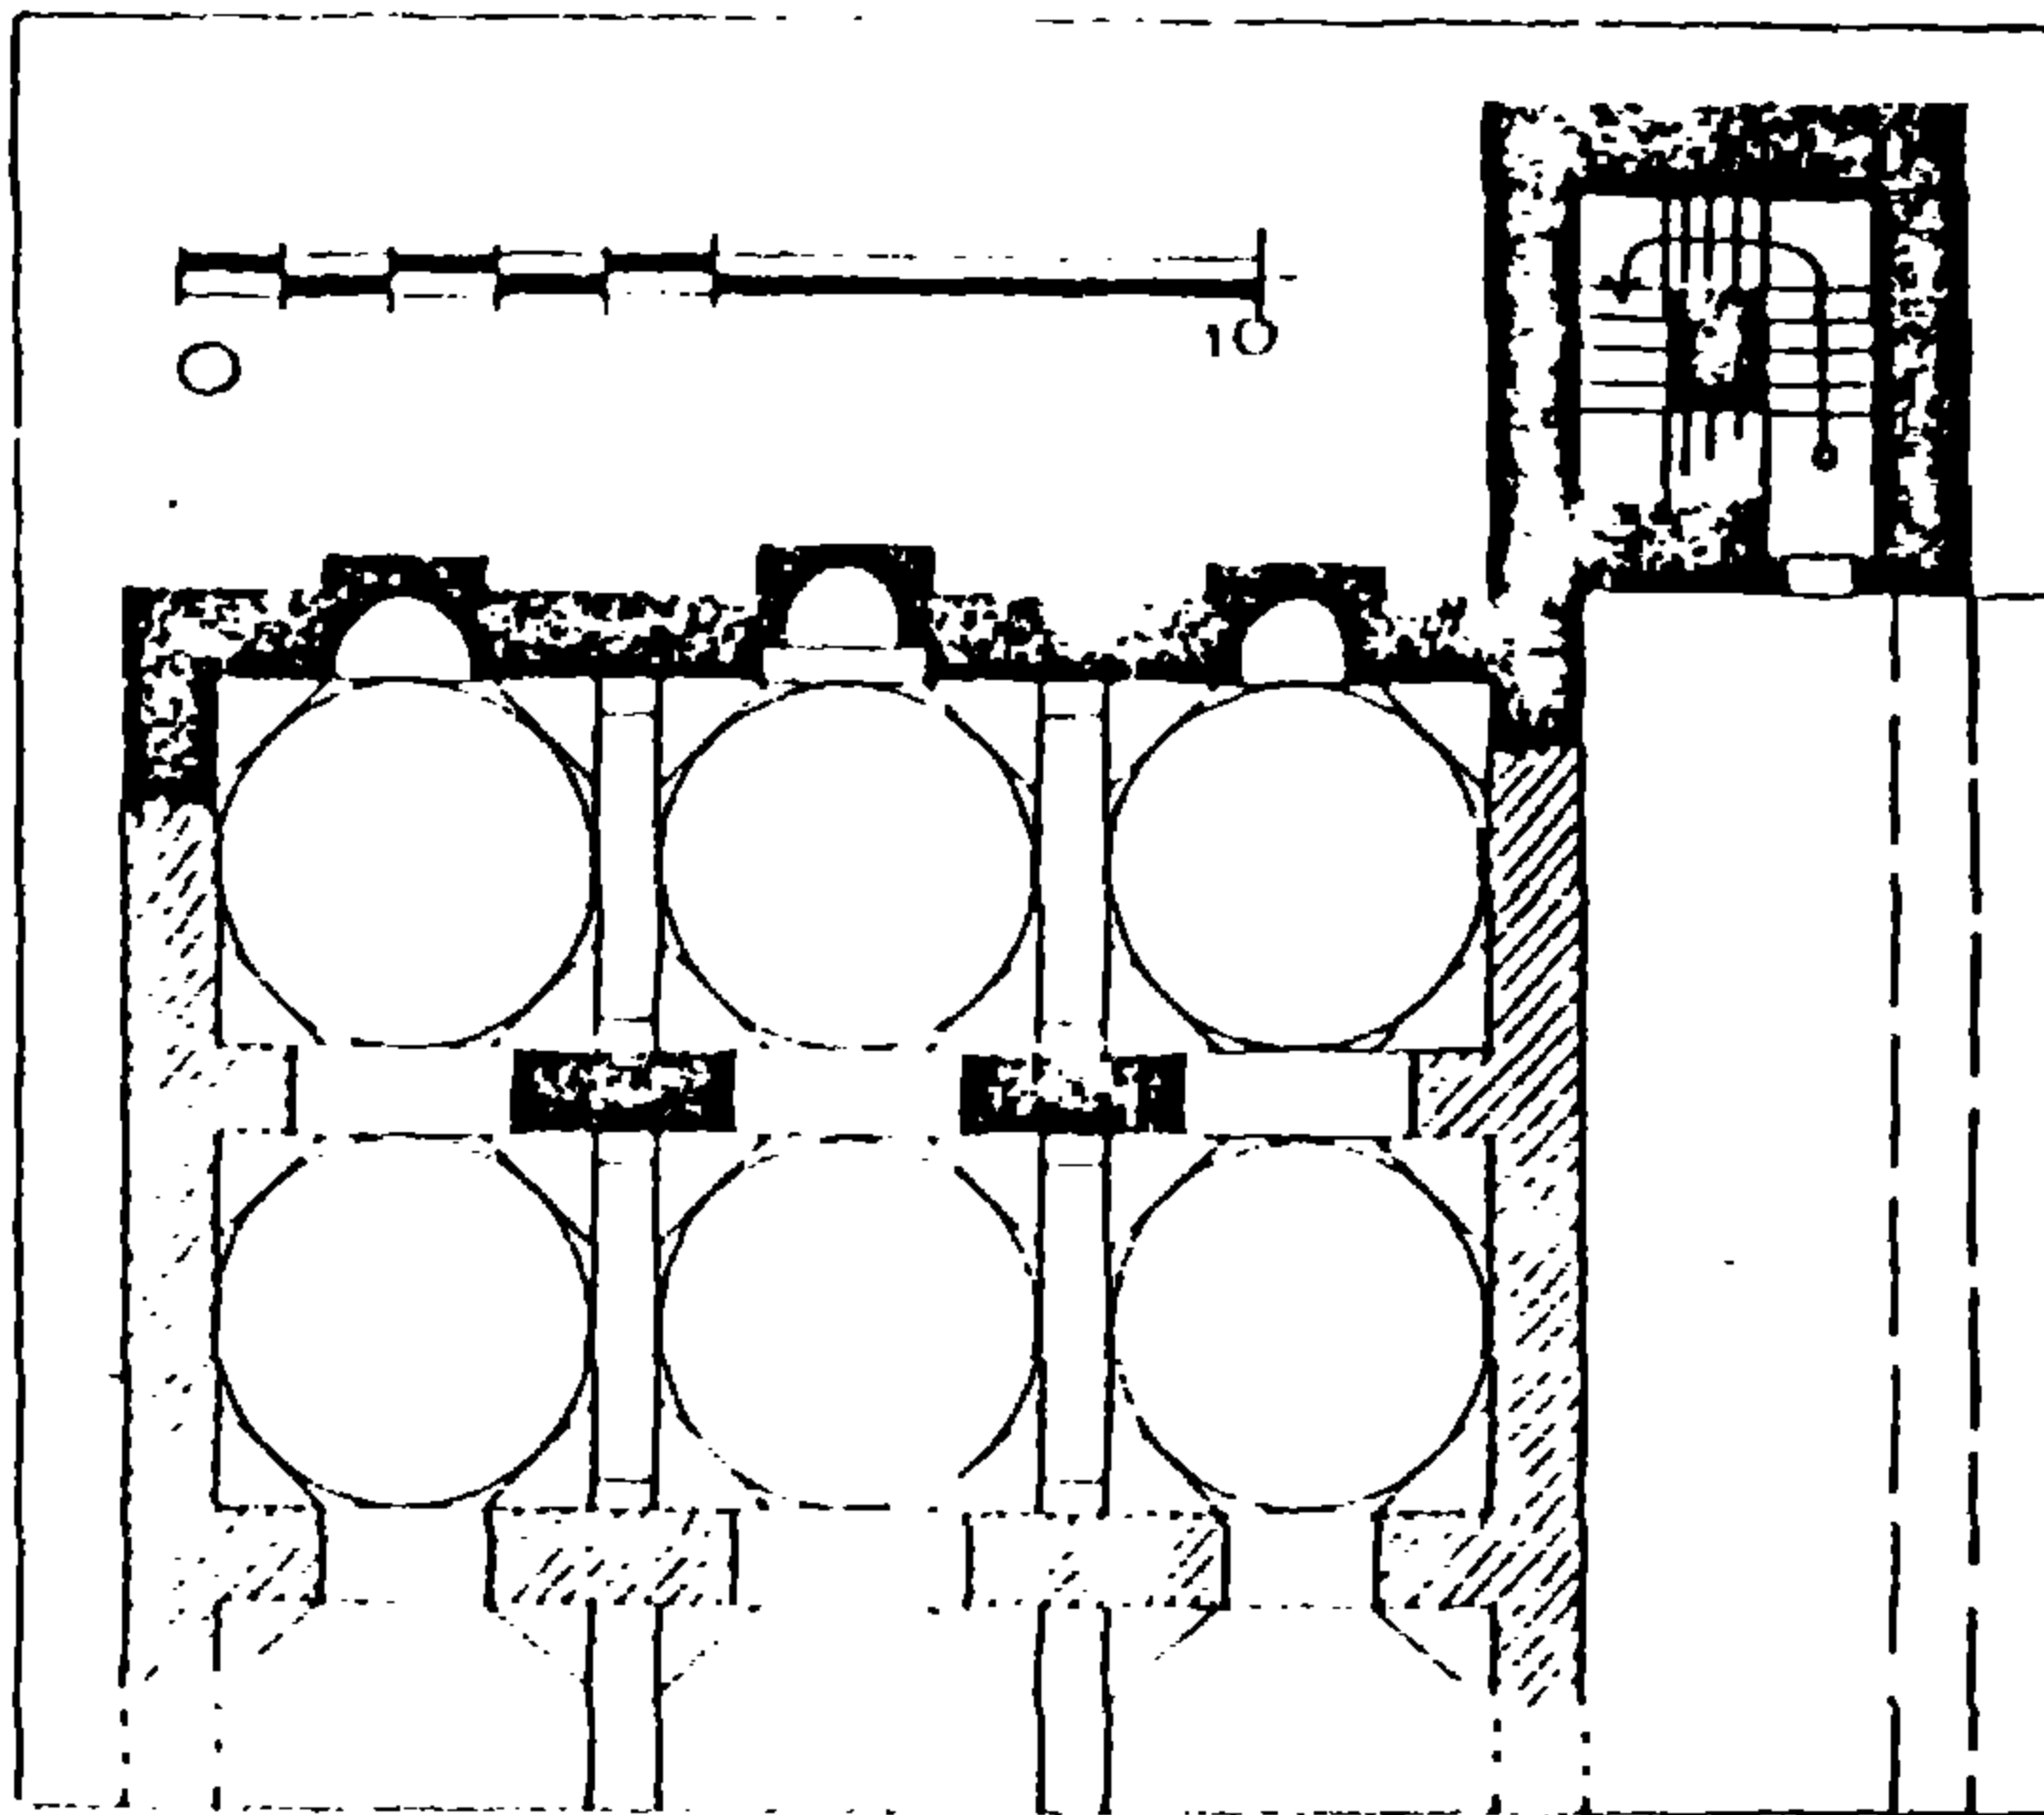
المسقط الأفقى لمشهد آل طباطبا
